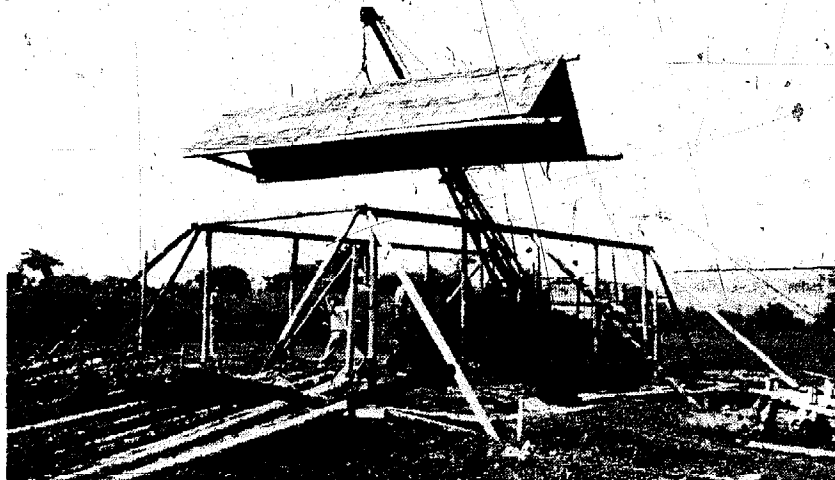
Colocación de la primera armadura. Nótese el arriostramiento horizontal y diagonal en la estructura portante.
